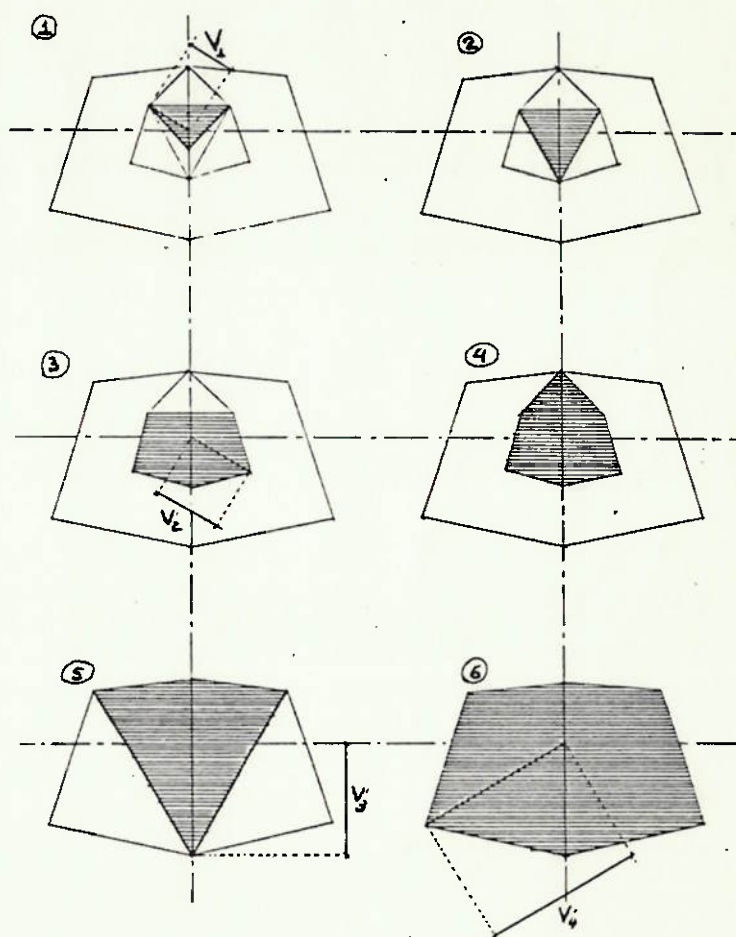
Sequência de detonação do pilar de três seções.
